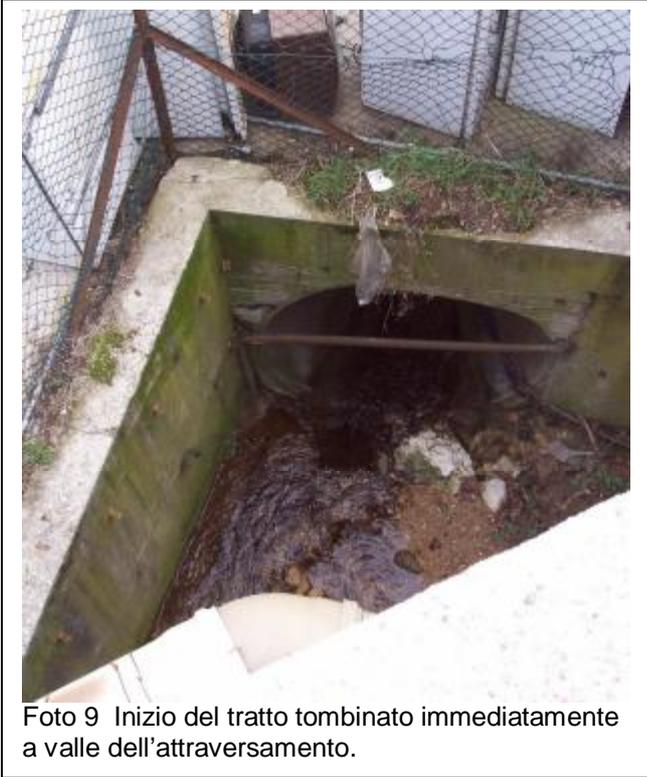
Inizio del tratto tombinato immediatamente a valle dell'attraversamento.
